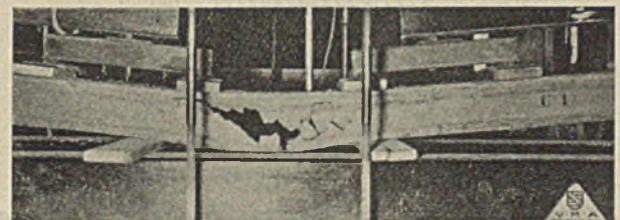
zeigt das sehr interessante Bruchbild eines Stahlsaitenbetonträgers; die Risse in der Zugzone haben sich wieder federnd geschlossen.
